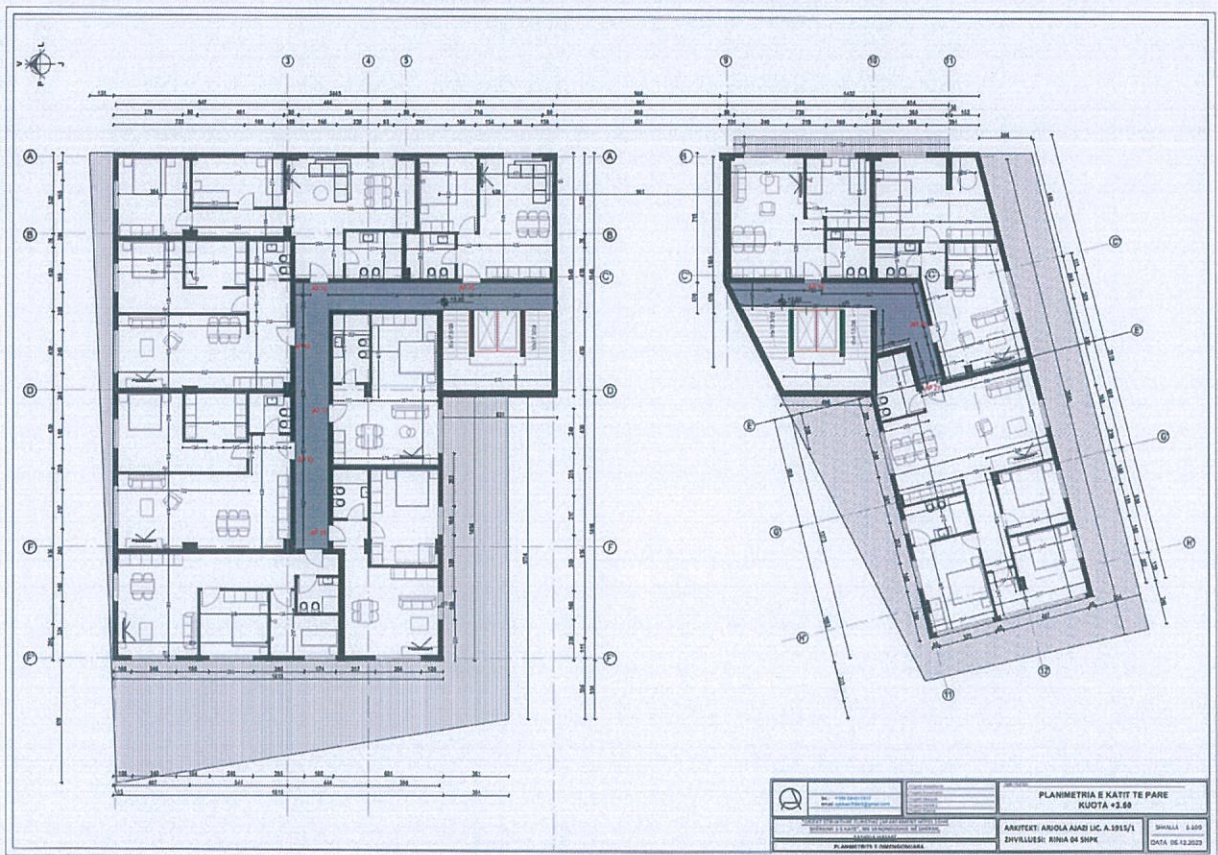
Planimetri e katit te pare (kuota 3.50)
